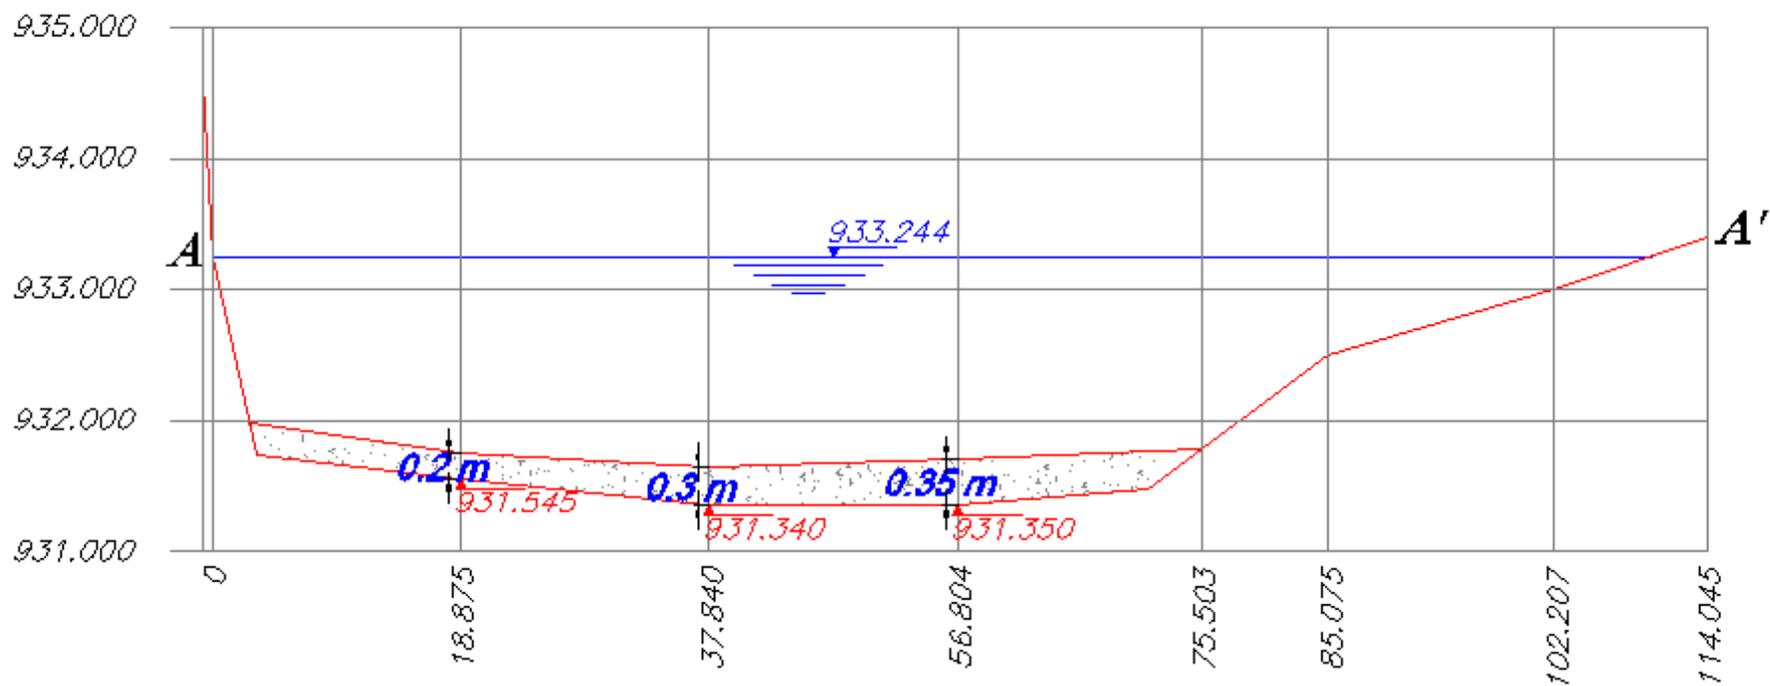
Perfil A – A' Madre Vieja Caraballo.
